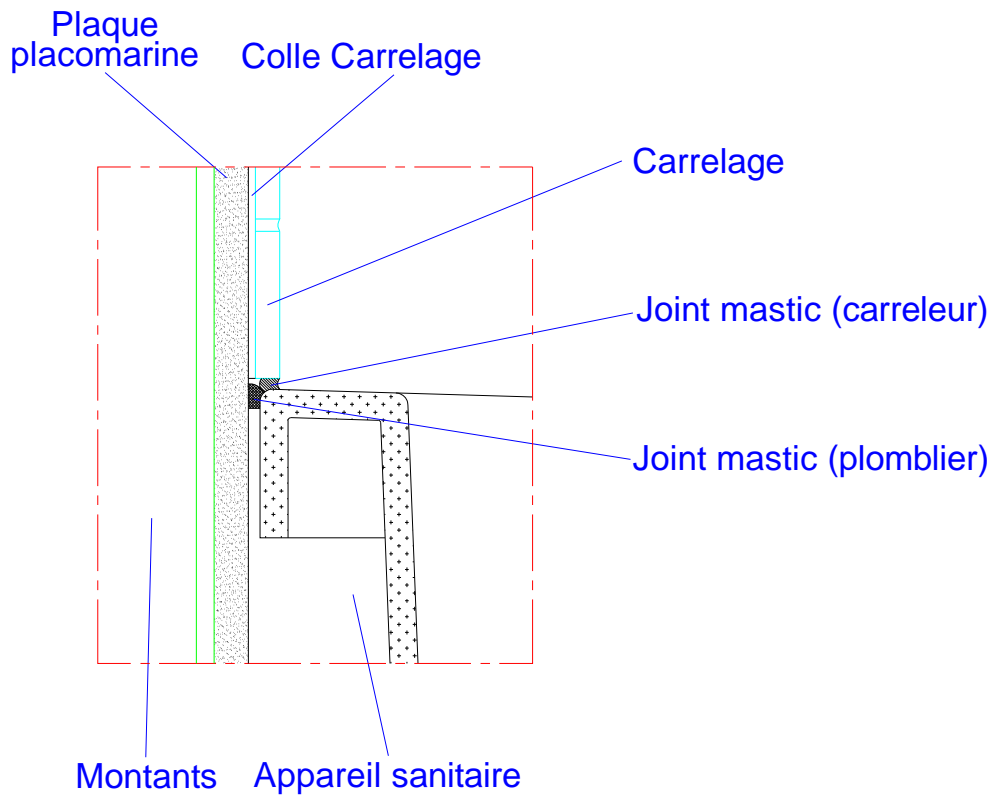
Liaison avec appareil sanitaire - local EB+ Privatif
